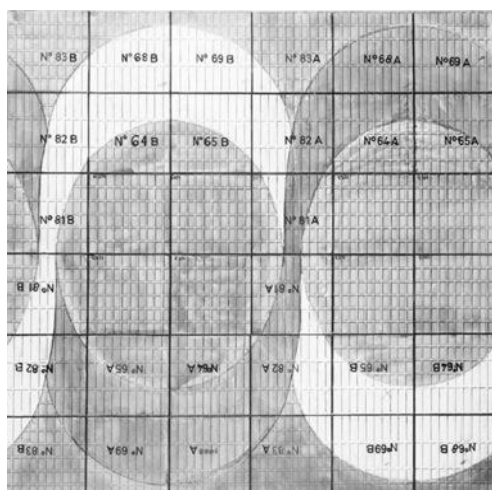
> Despiece de la pavimentación de la avenida Pau Casals (Arxiu Escofet)
